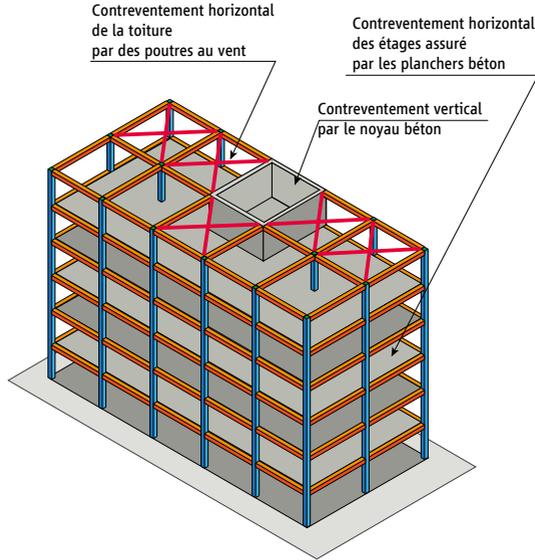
Bâtiment contreventé par les voiles du noyau central en béton
